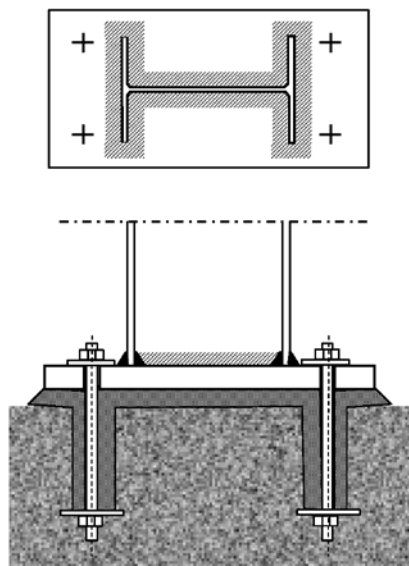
Connessione pilastro/parete – fondazione con piatto metallico e tirafondi dotata di rigidità flessionale.
